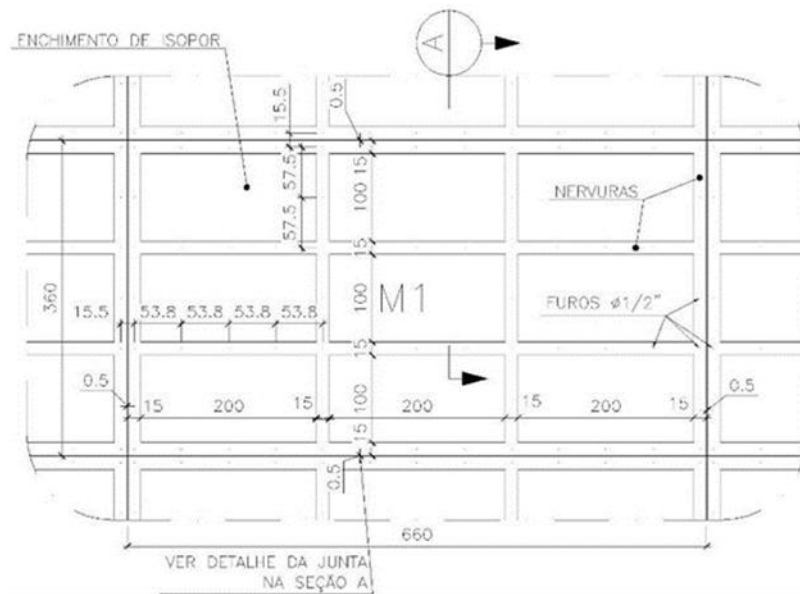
Reformulação do Greide – Piso Elevado – Módulo Típico – Seção A
